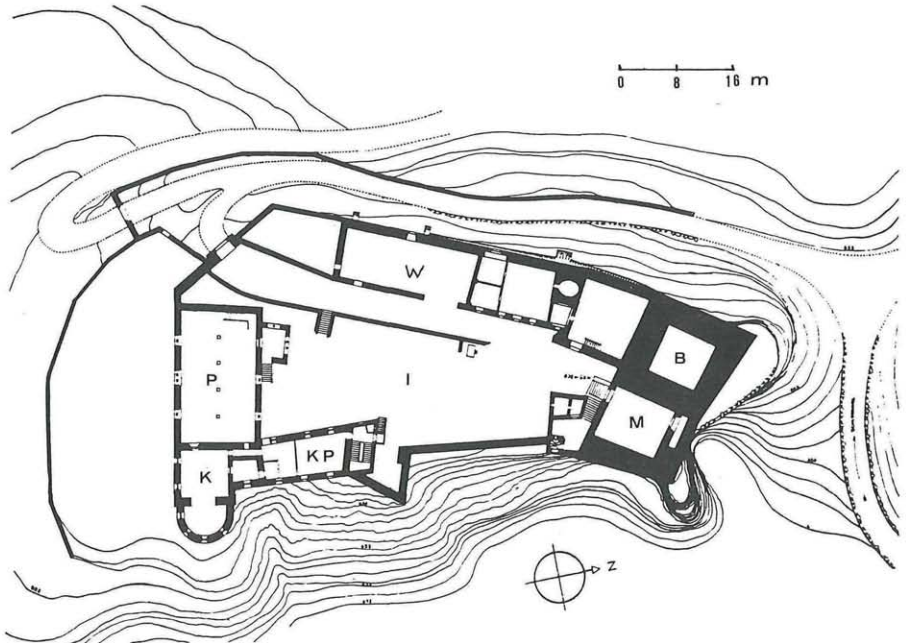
Lageplan von Schloß Tirol (aus TRAPP, 1973). – B – Bergfried, M – Mushaus, P – Palas, K – Kapelle, KP – Kaplanei, W – Wirtschaftsgebäude, I – Innenhof.
